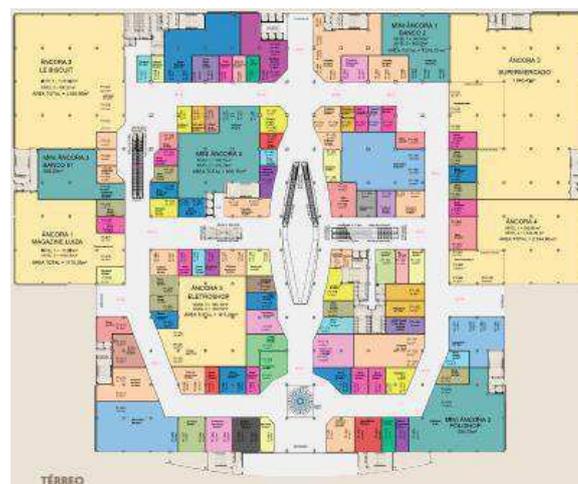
PLANTA BAIXA TÉRREO (P1)
